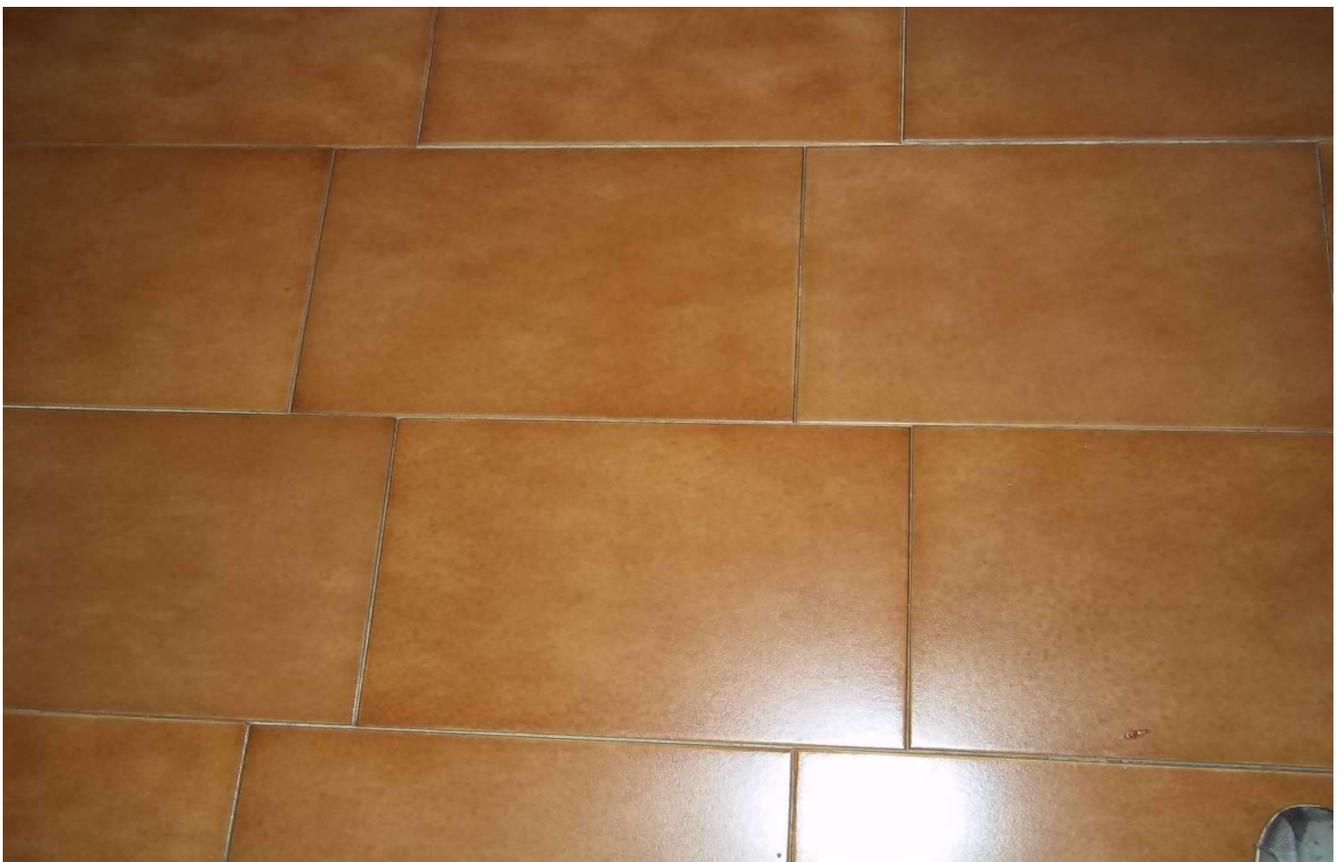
particolare pavimento fabbricato - lotto 2 –
